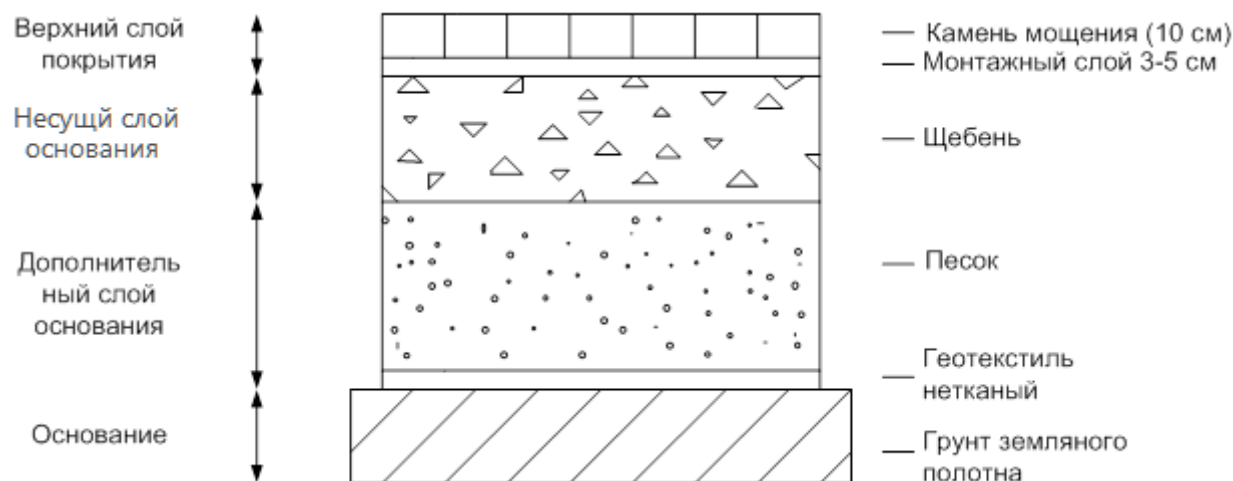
Конструктивная схема тротуаров N3 без армирования
